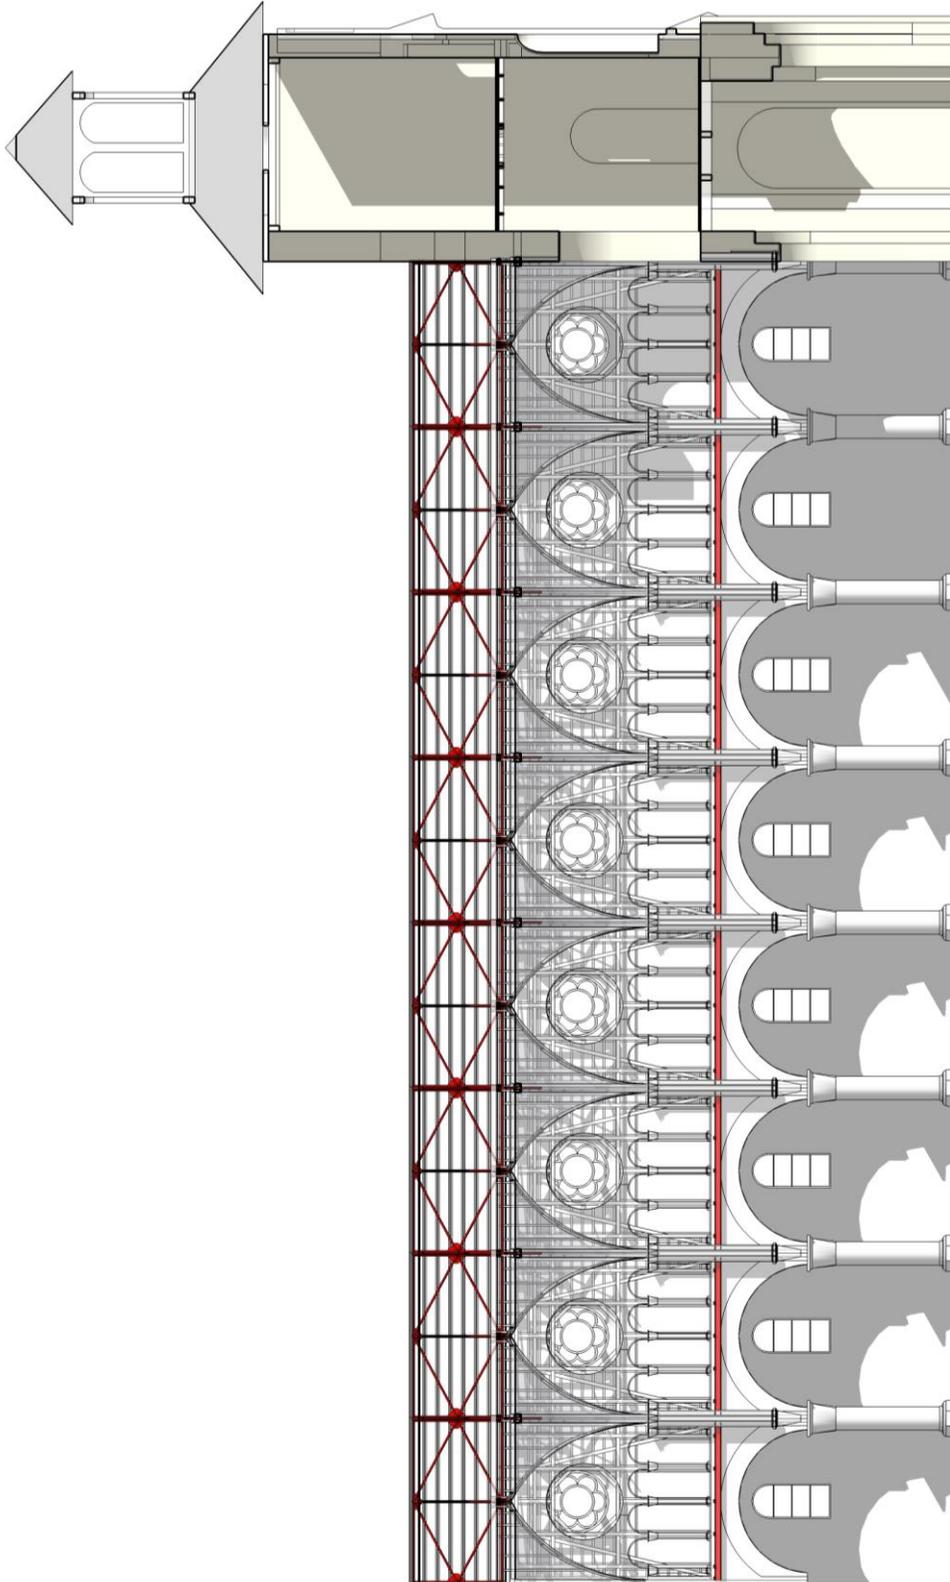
Corte transversal, en rojo estructura metálica consolidada, con piezas incorporadas en tabiquería sobre arcada. Elab. Propia.
